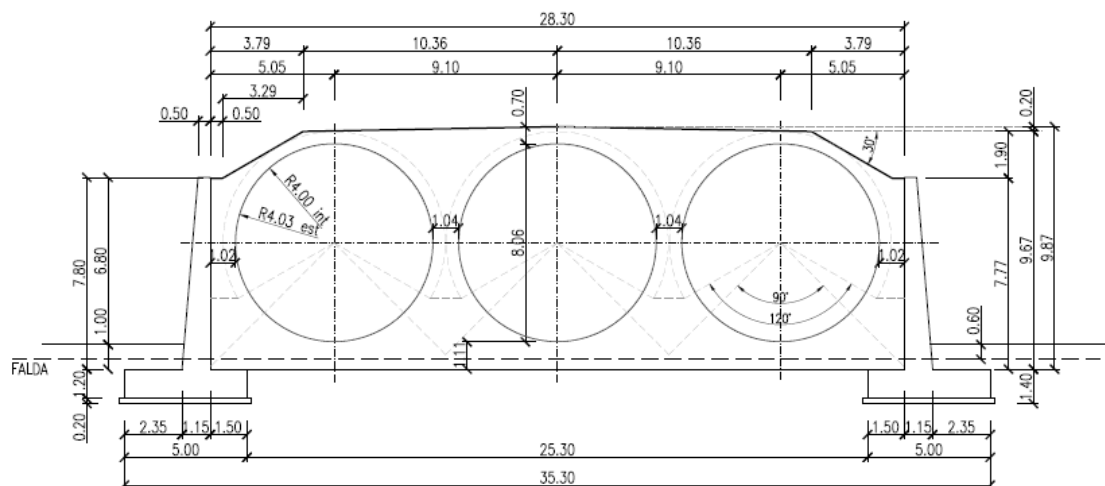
Sezione trasversale opera su fondazioni dirette.
